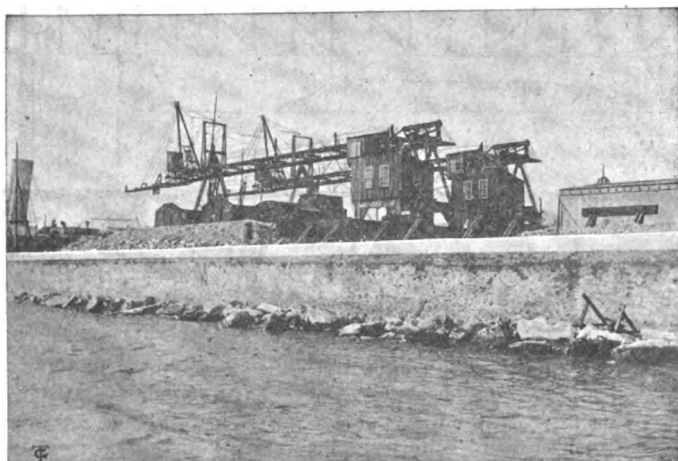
Elevatori Brown sul ponte B. Assereto. - Vista.
